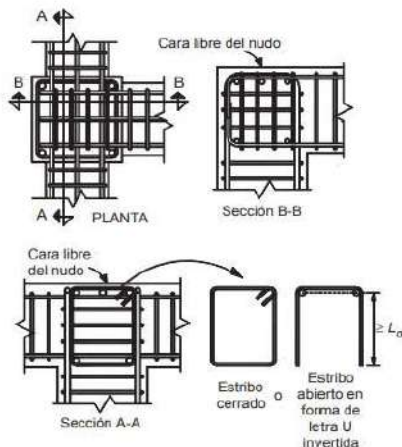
Refuerzo transversal vertical en uniones viga – columna
